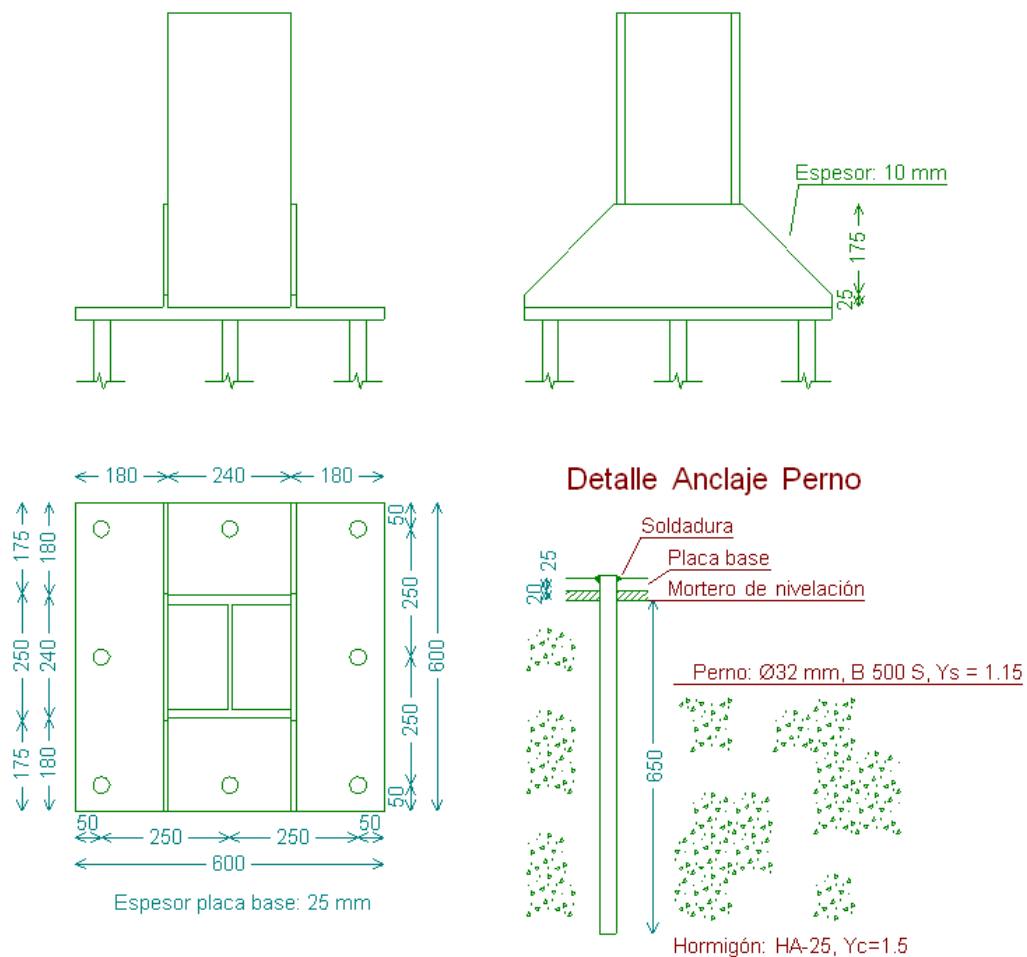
Placas de anclaje pilares de los pórticos intermedios (pórticos en celosía)
